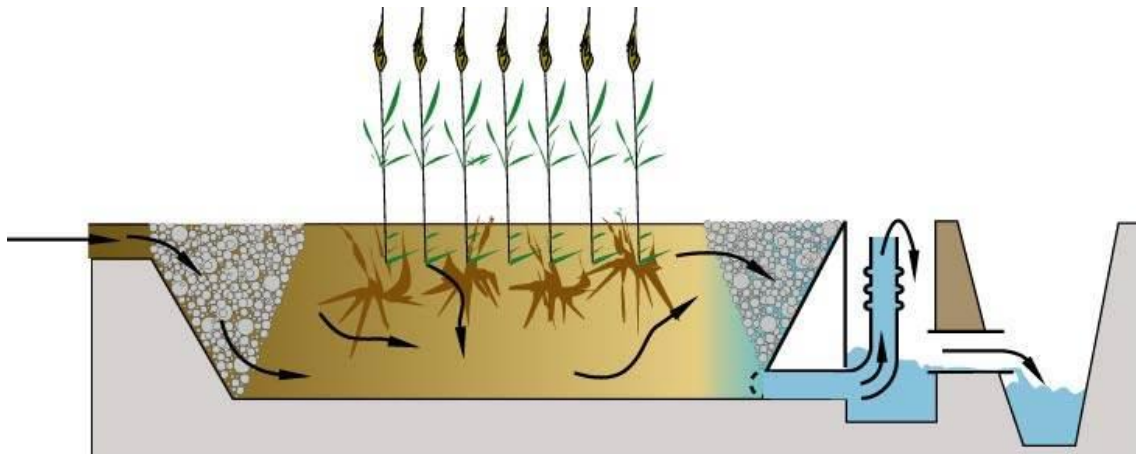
Detalhe da retenção construída (Fonte: Nestor, 2014).
